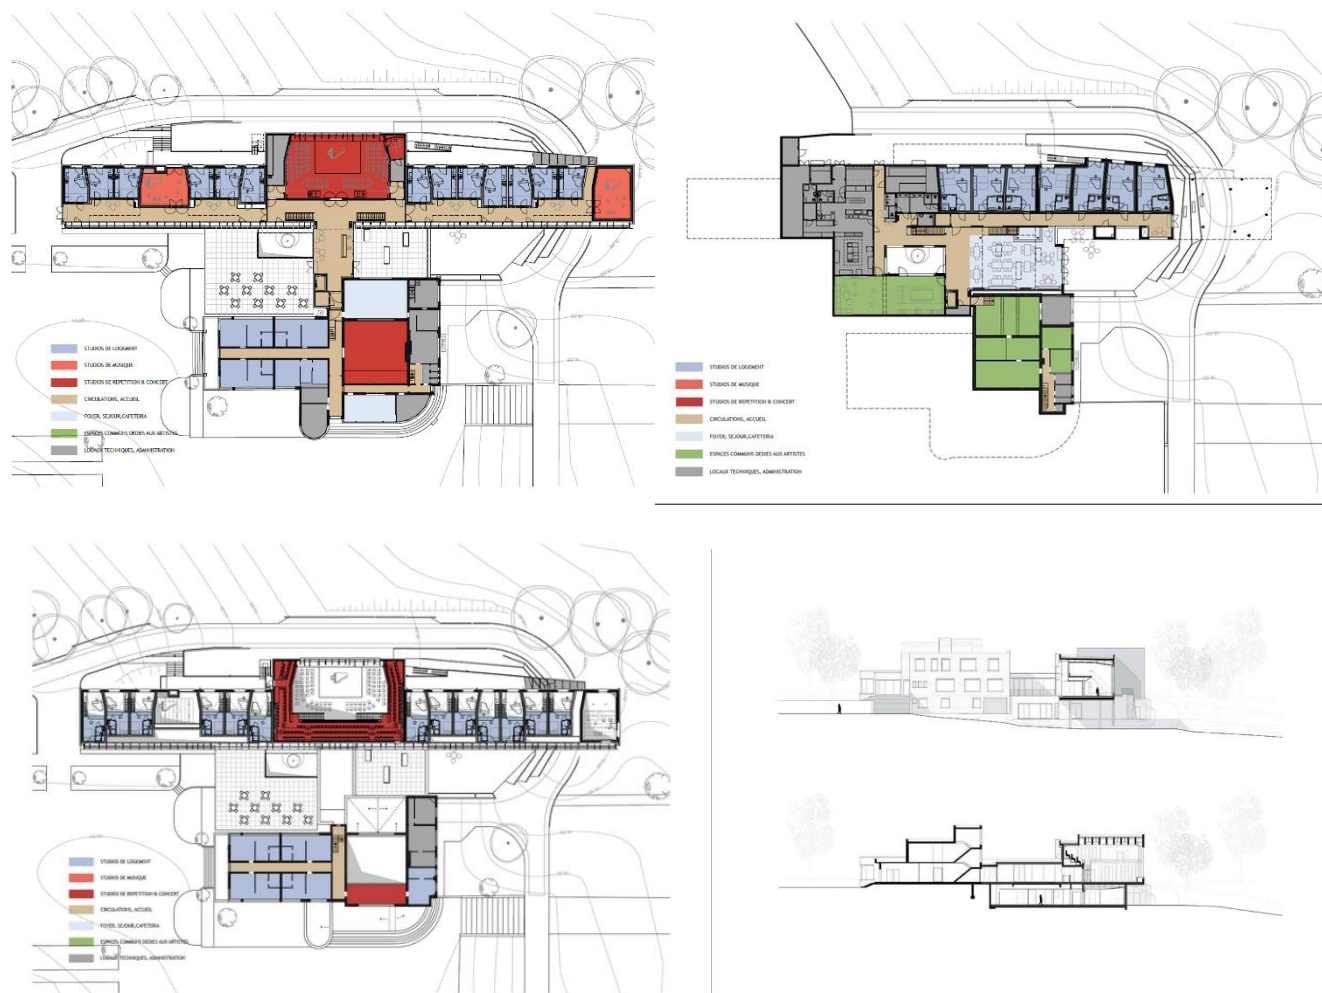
Plans de la chapelle musicale Reine Élisabeth.
